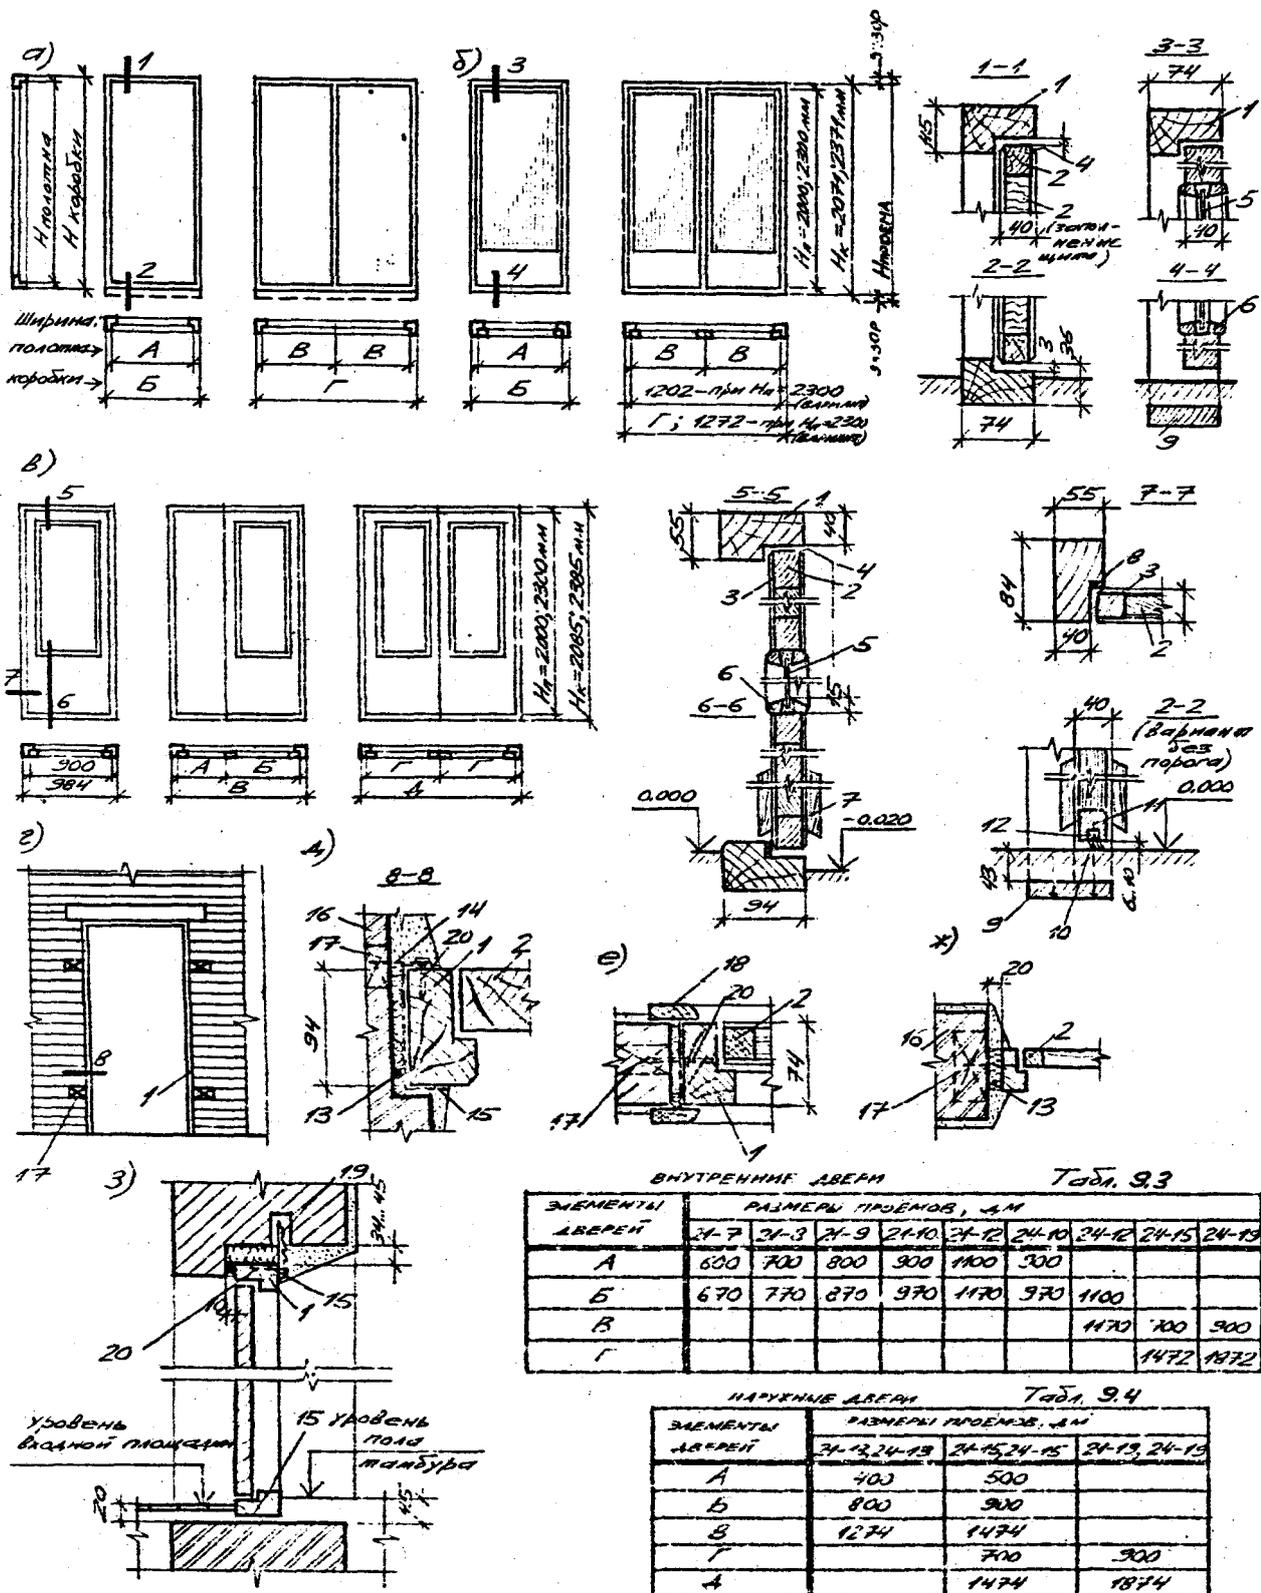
Наружные и внутренние двери жилых и общественных зданий: а, б - деревянные внутренние щитовые (а - глухие с пазом в четверть и четверть, б - остекленные с пазом в четверть); в - деревянные наружные щитовые; 2 - расположение проема в кладке; 4 - крестовые дверного блока к наружной стене; е, ж - то же к перегородке (к внутренней стене); 3 - установка дверного блока в наружную стену; 1 - дверная коробка; 2 - щит полотна из деревянных брусков (реек); 3 - обшивка из ДВП; 4 - фанла; 5 - стекло; 6 - шпатель; 7 - пинтус; 8 - уплотняющая прокладка; 9 - монтажная доска; 10 - прокладка из резины; 11 - шуруп; 12 - решетка; 13 - конопатка; 14 - баш; 15 - сталь; 16 - стена (перегородка); 17 - деревянная антисептированная пробка; 18 - наличник; 19 - костыль; 20 - гвоздь
